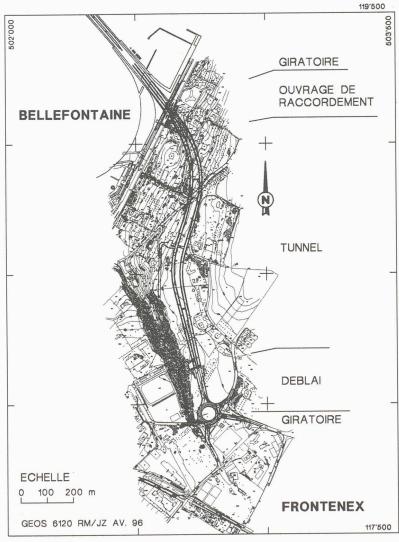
Tunnel de liaison Bellefontaine – Frontenex: tracé en plan
